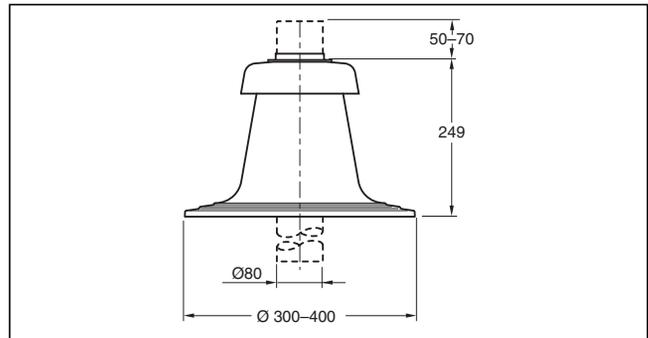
Schachtabdeckung für 110 mm (Maße in mm)
